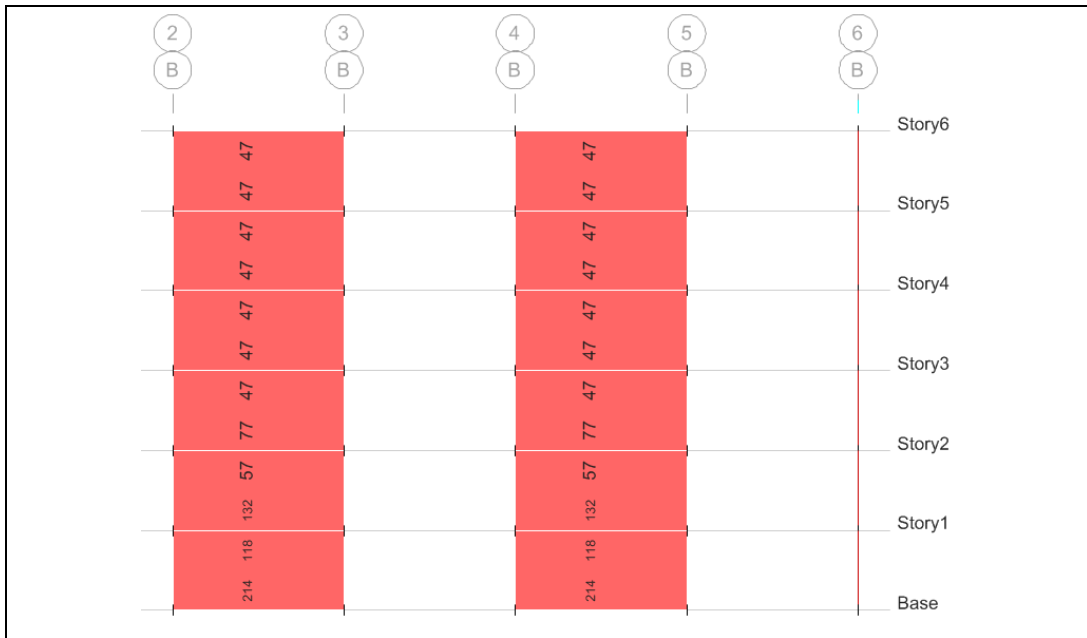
Área de refuerzo longitudinal en los muros M1 y M2,
